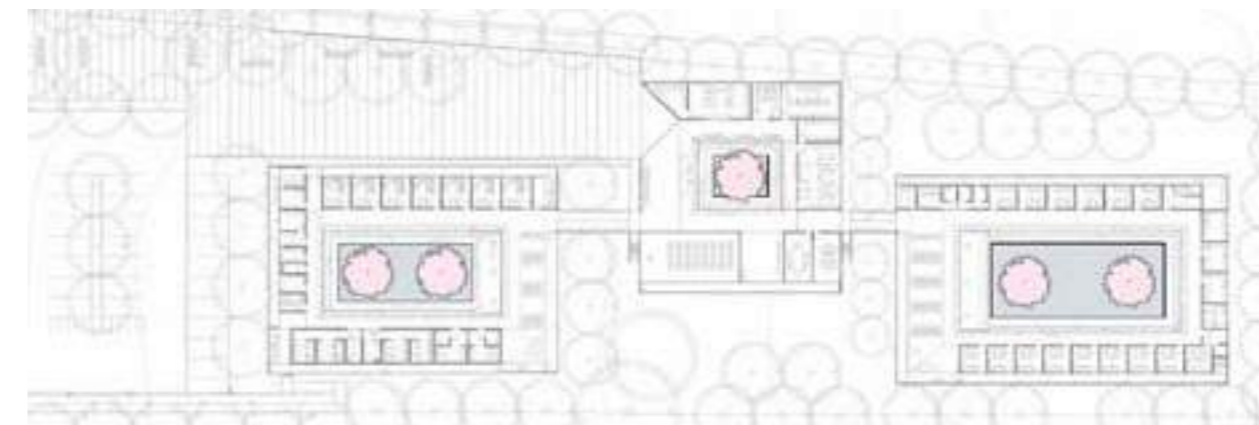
Planta baja Fuente: Saboia+Ruiz Arquitetos
